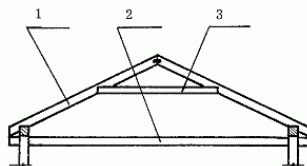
Наслонные стропила: 1 – стропильная нога; 2 – ригель; 3 – затяжка
